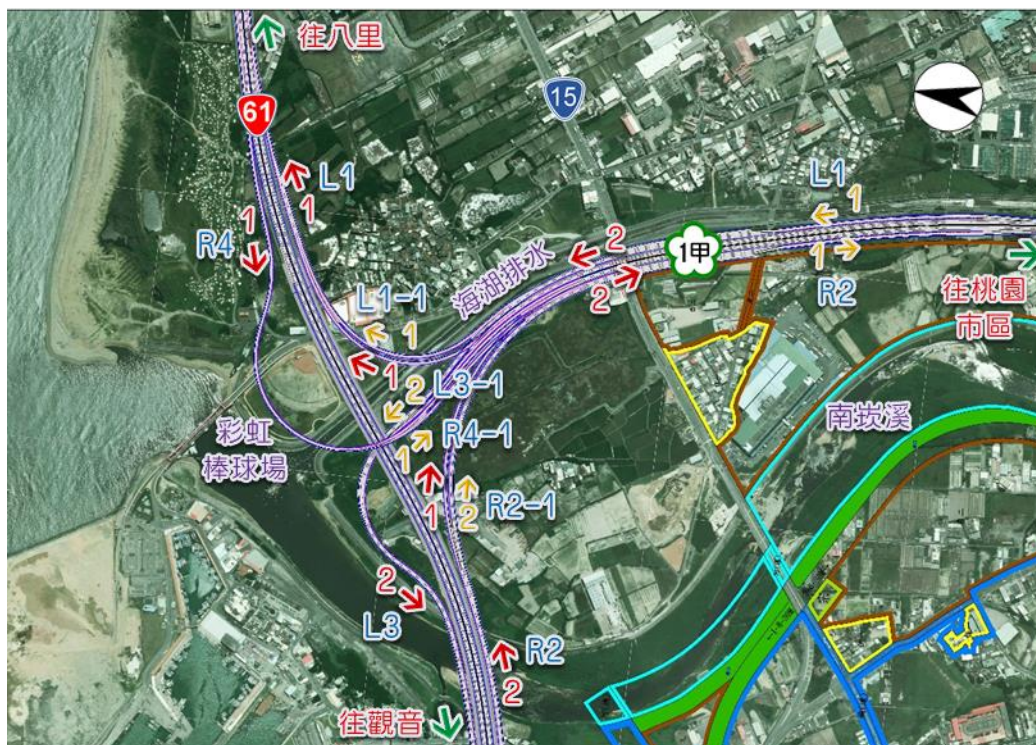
台 61 系統交流道方案三平面示意圖
